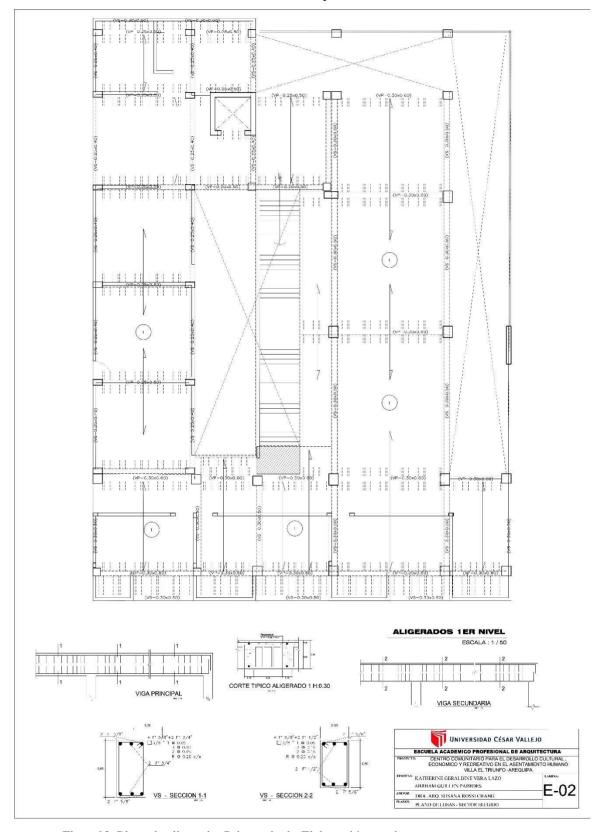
Plano de aligerados Primer nivel - Elaboración propia
